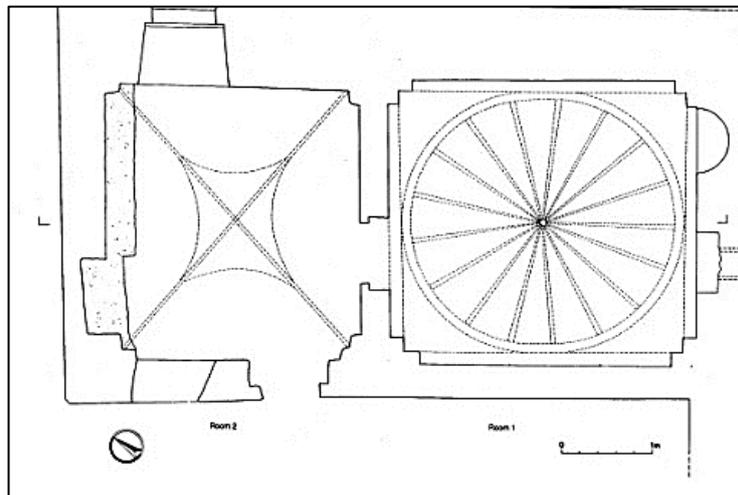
Plan des deux salles du bain de Santa Chiara. Source ARTHUR²⁵⁰
